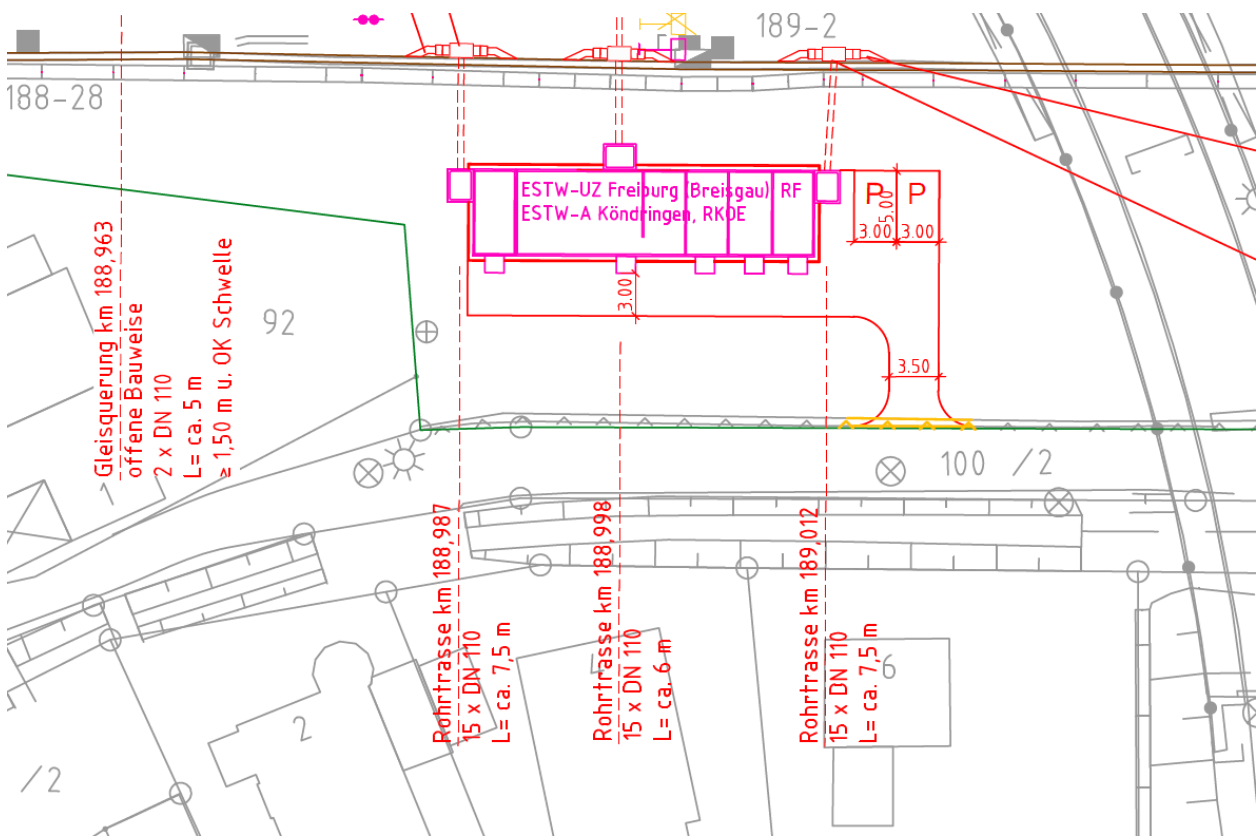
Lageplan des Modulgebäudes mit Zufahrt und Parkplätzen
